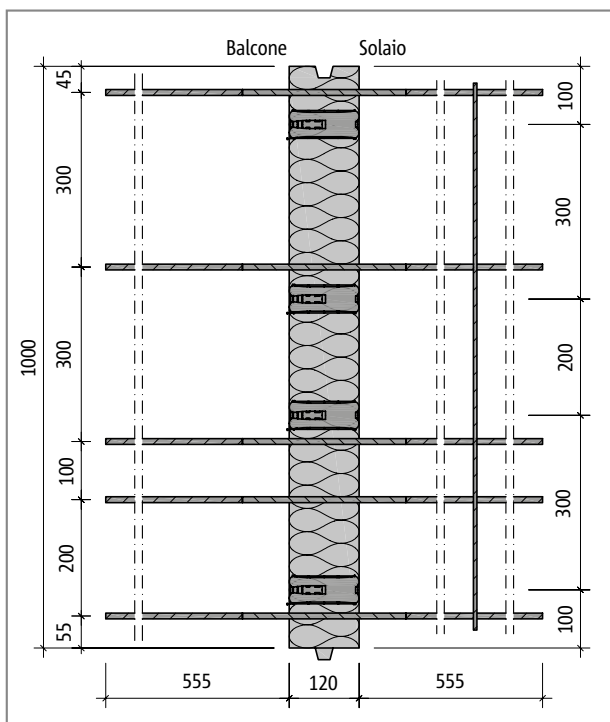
Schöck Isokorb® tipo QXT70: pianta del prodotto
